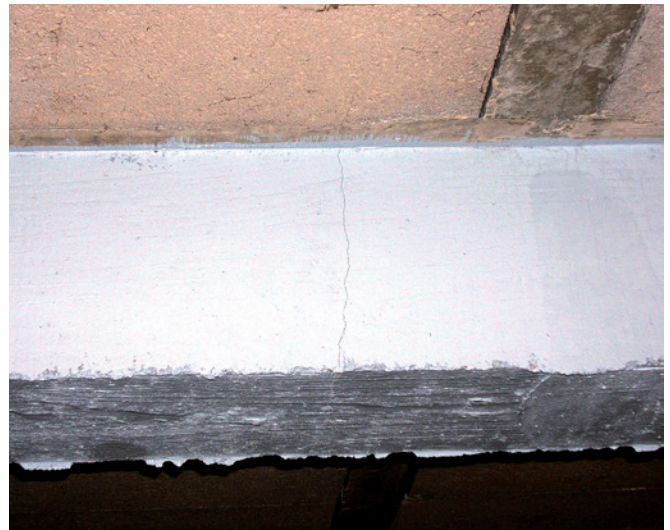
La fissure visible sur cette poutre fait suite à son fléchissement. Le ferrailage est vraisemblablement insuffisant.
